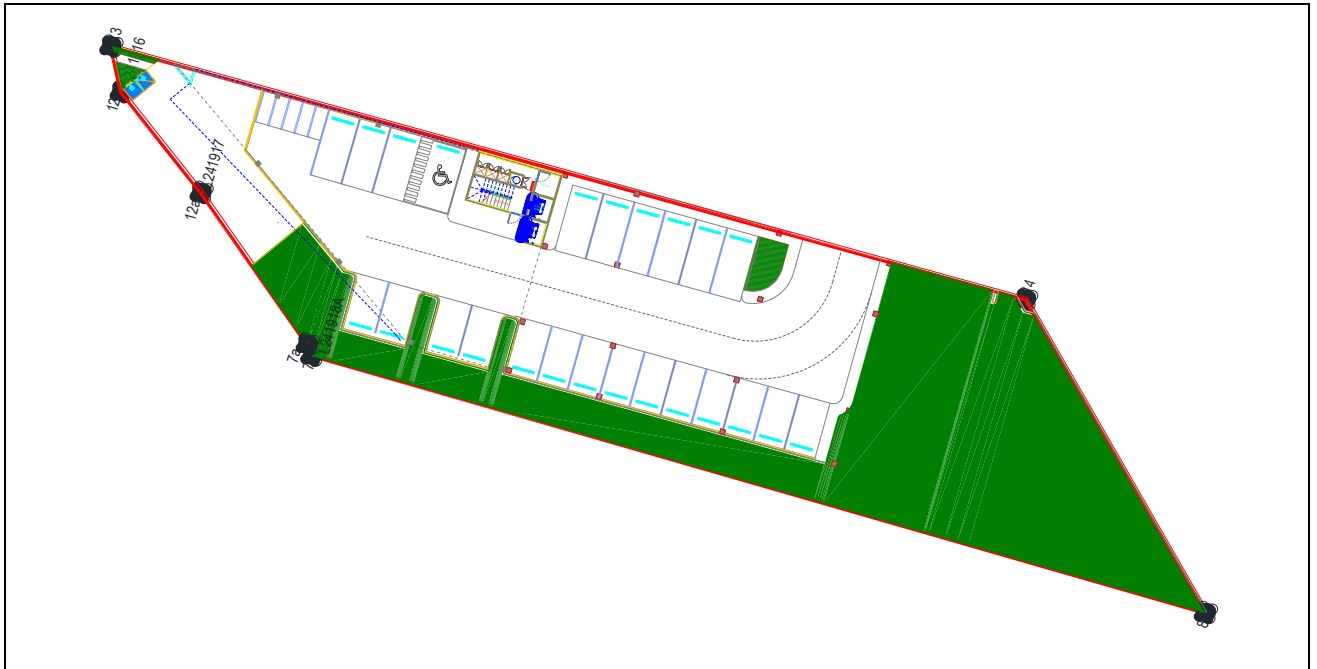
Huella de los componentes que conforman el proyecto en planta baja.
